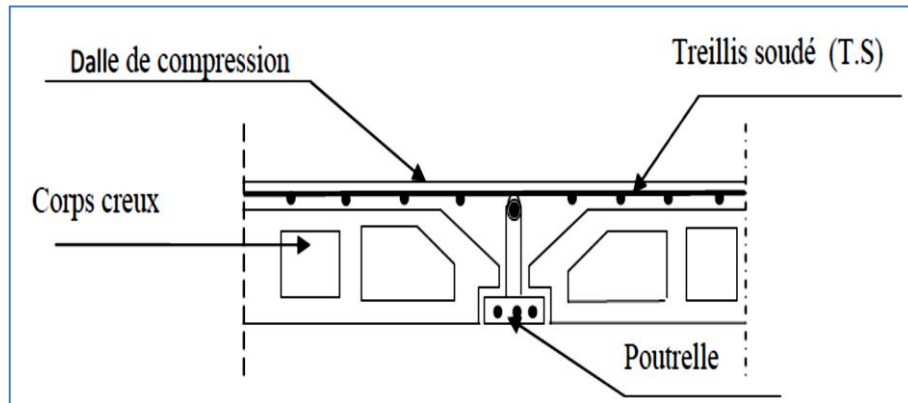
Coupe verticale sur un plancher en corps creux.
